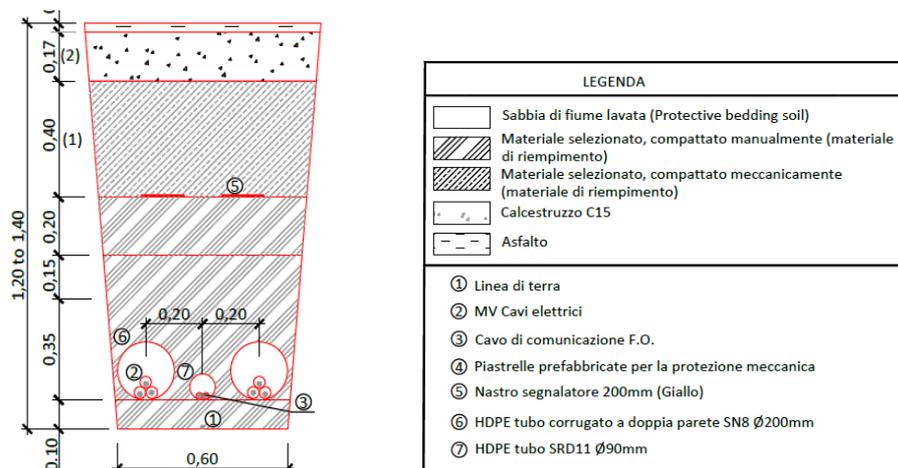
sezione tipo cavidotto su viabilità pubblica
